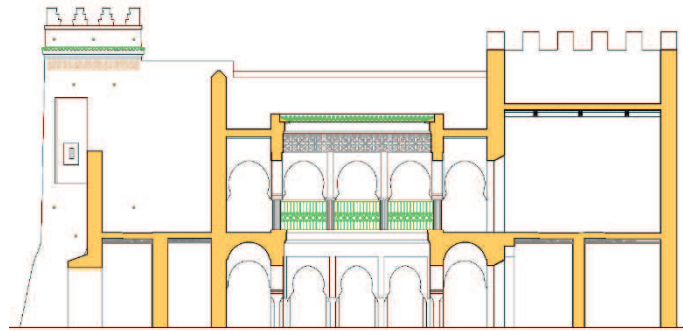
Coupe sur Dwayriyyet Ahl El-Abd, (échelle : 1/200).
